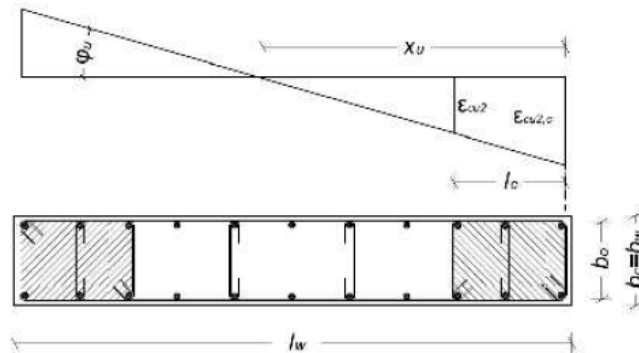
Elementi di bordo di una parete, diagramma delle corrispondenti curvature, schema esemplificativo delle armature di confinamento
